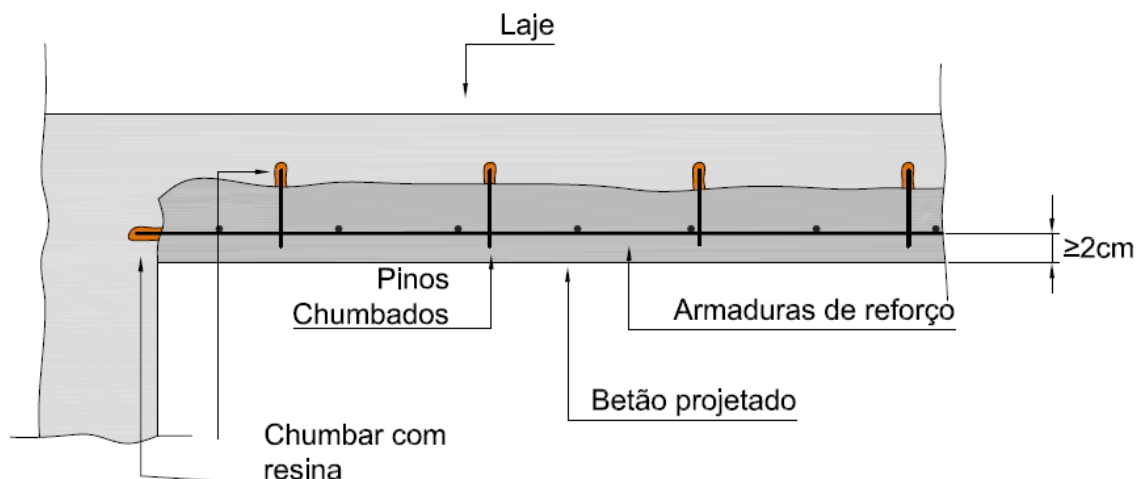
Reforço da face inferior de uma laje, com betão projetado, adaptado de [19].
